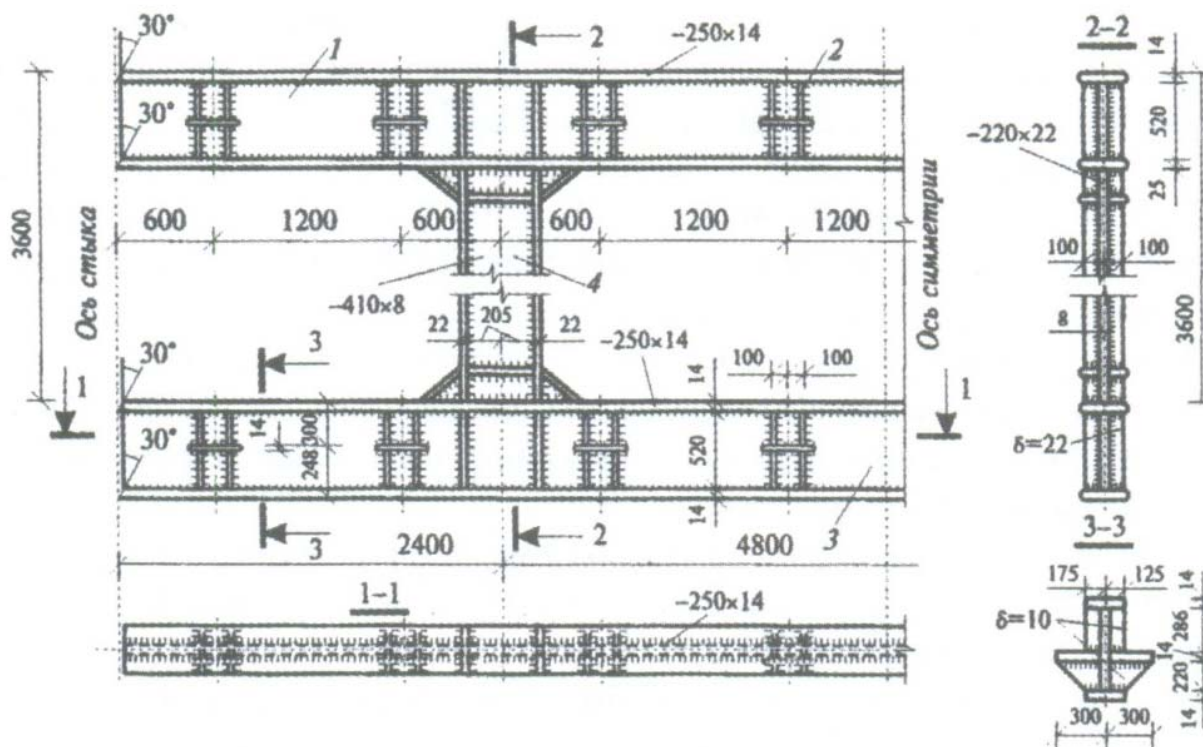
Конструкция ригеля – металлической безраскосной фермы:
